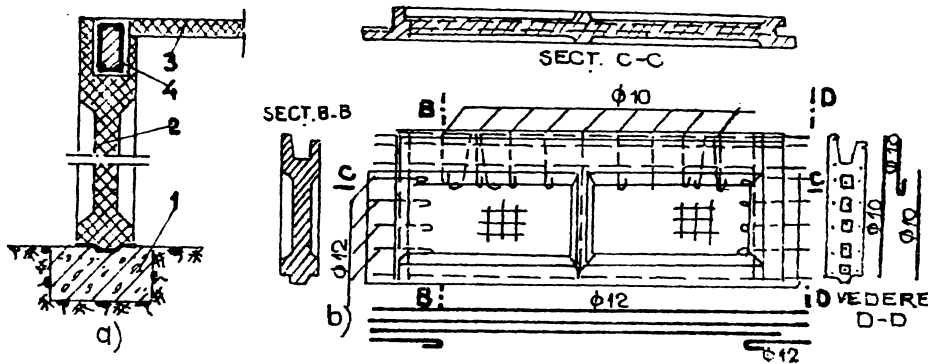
Soluție de prefabricare a elevațiilor (Catedra de drumuri și fundații din Timișoara, 1974): a-secțiune verticală prin fundație; b-panou casetat pentru elevație; 1-talpă monolită; 2-panou de elevație casetat; 3-planșeu peste subsol prefabricat; 4-centură de monolitizare elevație-planșeu subsol.
